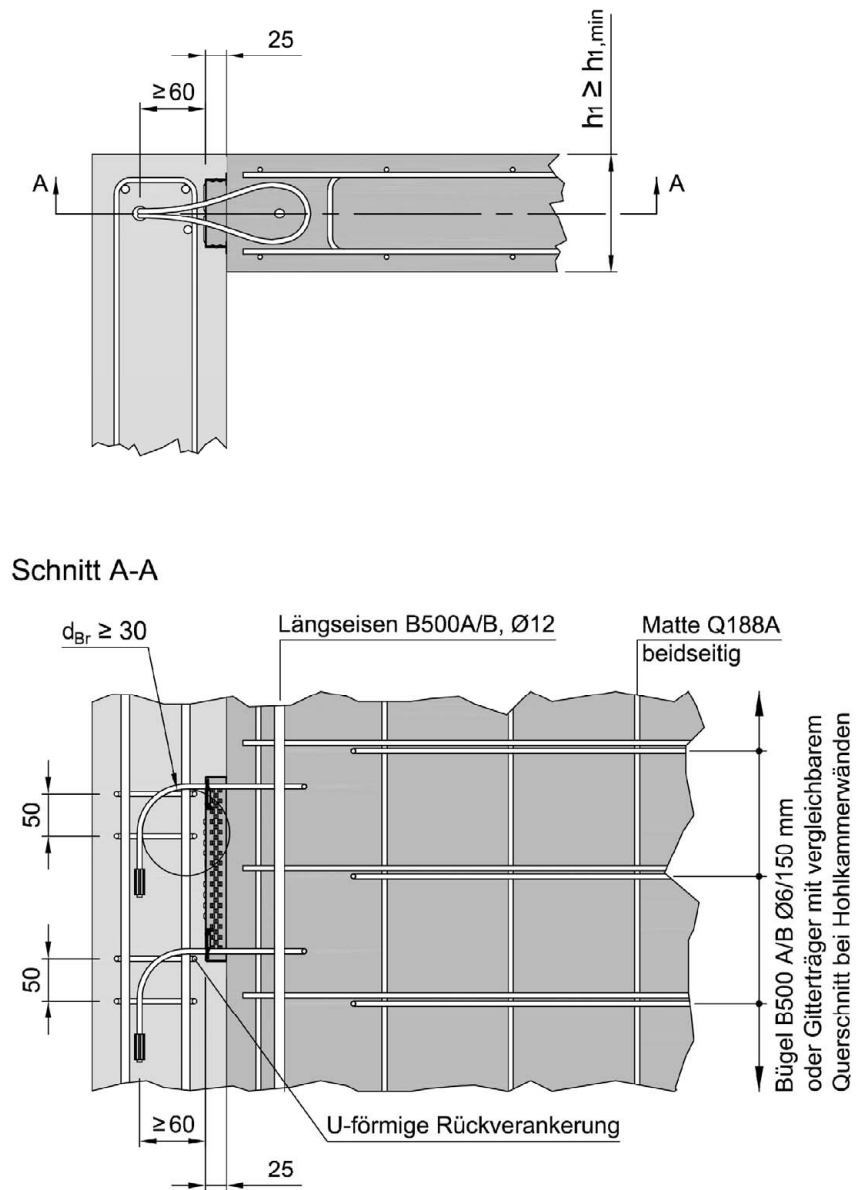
Eckverbindung mit abgewinkelten Seilschlaufen, Abmessungen, Bewehrung
